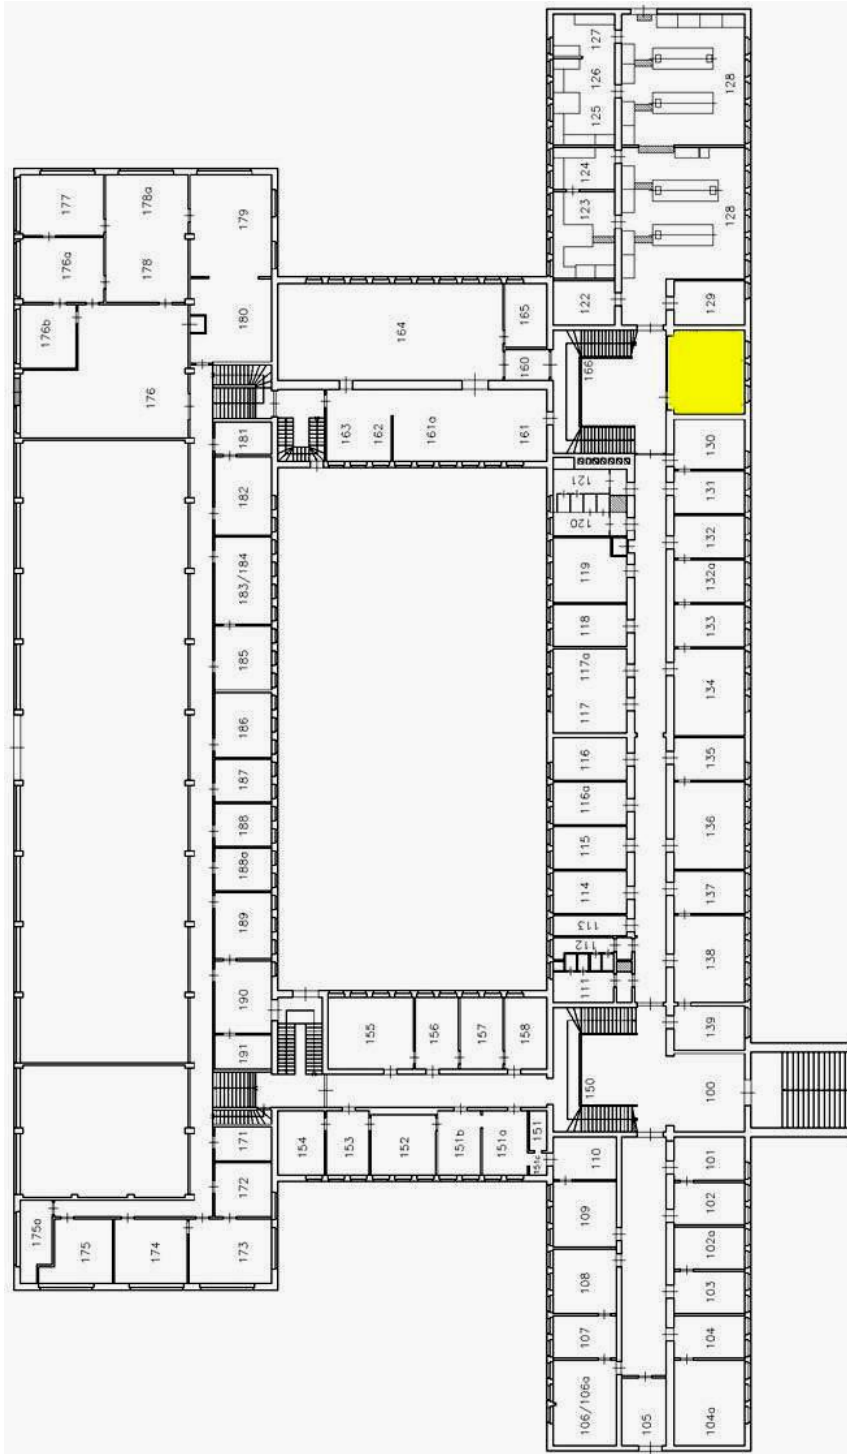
Grundriss SZMF-Hauptgebäude Erdgeschoss
